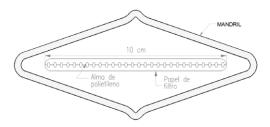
Sección de un dren de plástico y papel de filtro y del mandril (Uriel, 1991, citado en Zamora, 2014).
